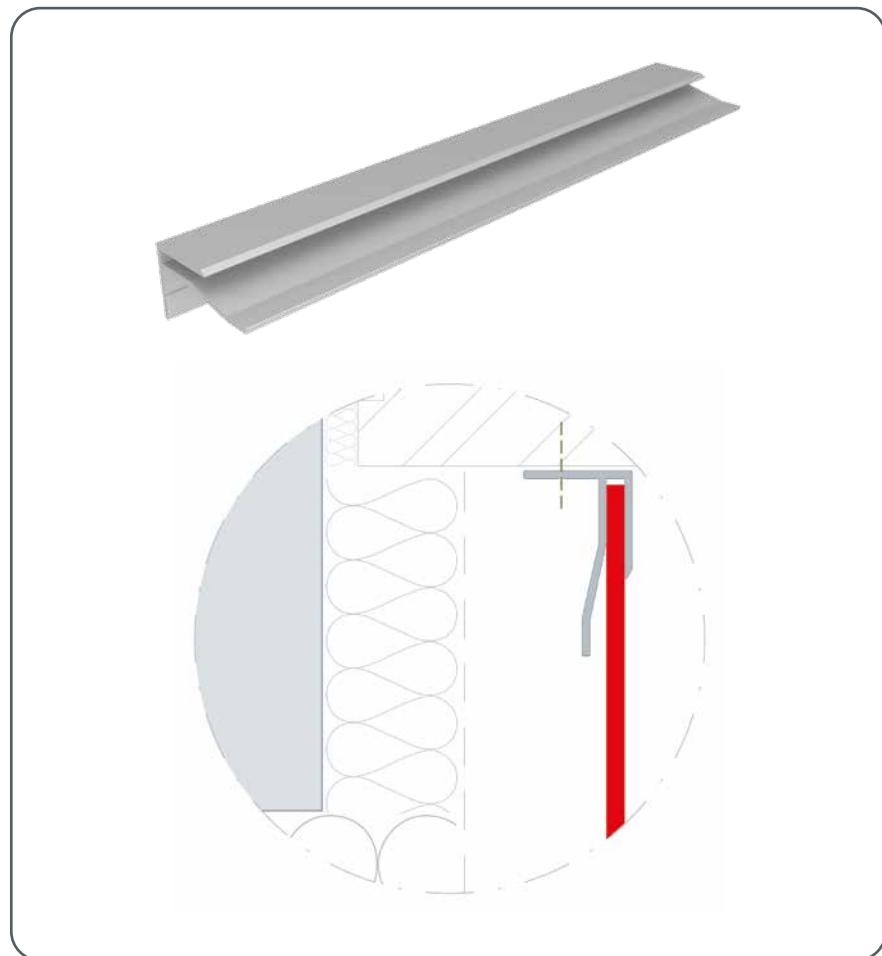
• Profilo a F (fissaggio direttamente sul telaio della finestra)
